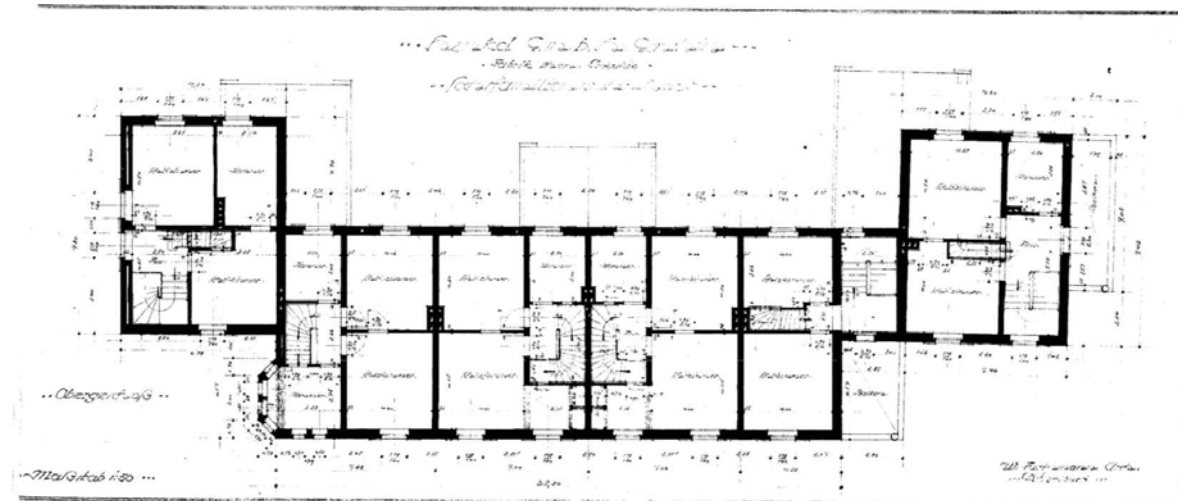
Sechs-Familien-Wohnhaus, Grundrisszeichnung von 1926
